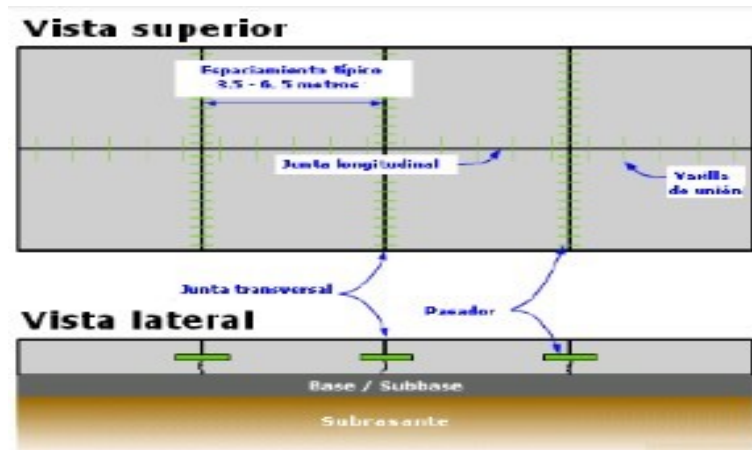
Pavimento e concreto simple. Fuente: Salgado, M. 2017.
